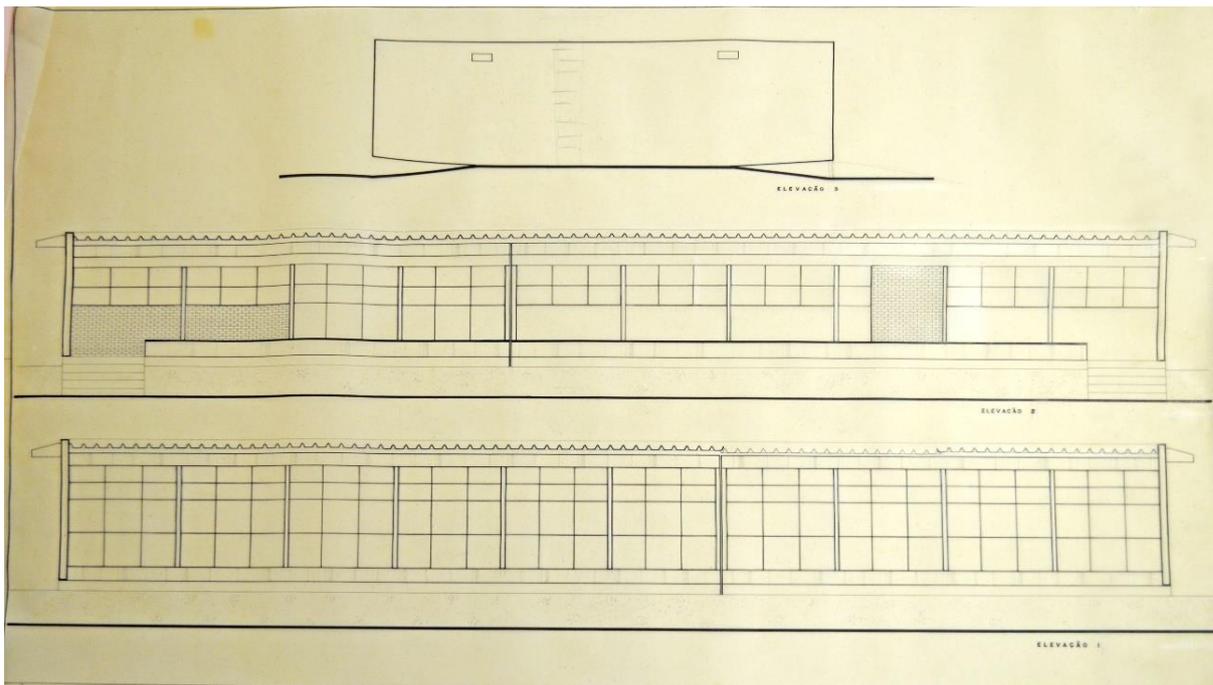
Fachadas frontal (Elevação 2), posterior (Elevação 1) e lateral (Elevação 3) do projeto do Laboratório de Ecologia (1980).
